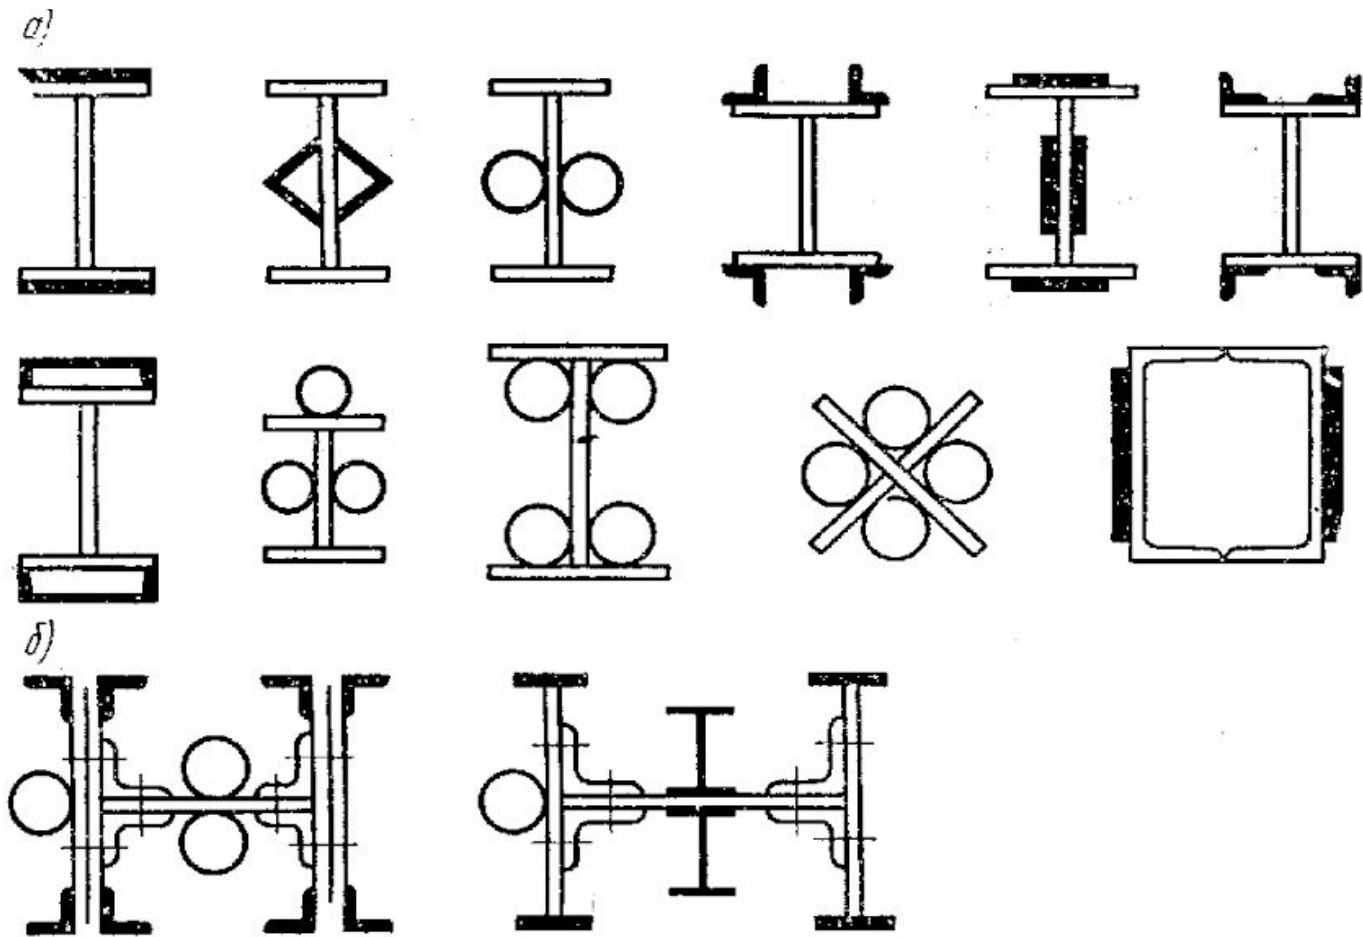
Усиление стоек и колонн многоэтажных зданий и сооружений увеличением сечений
